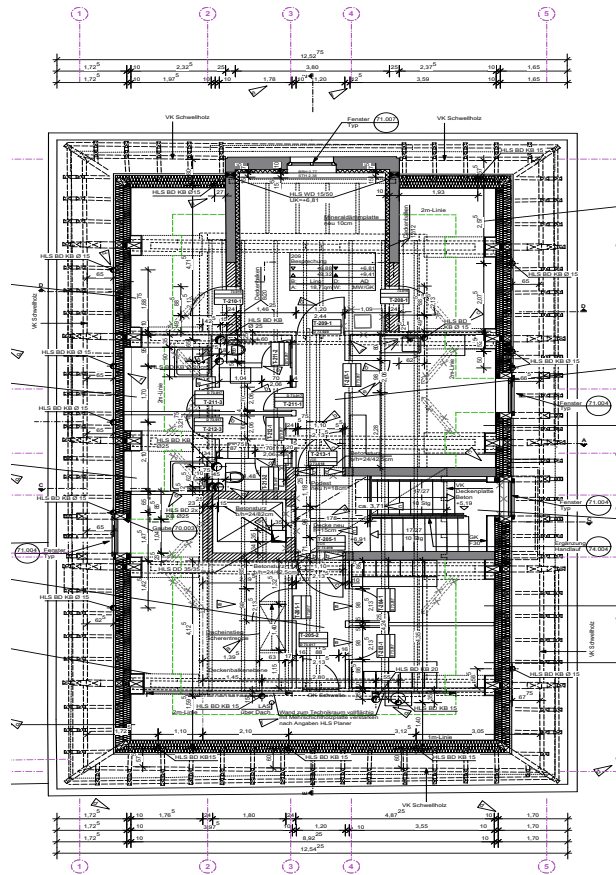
Bestandsplan der Vogtei, Dachgeschoss, 2015
